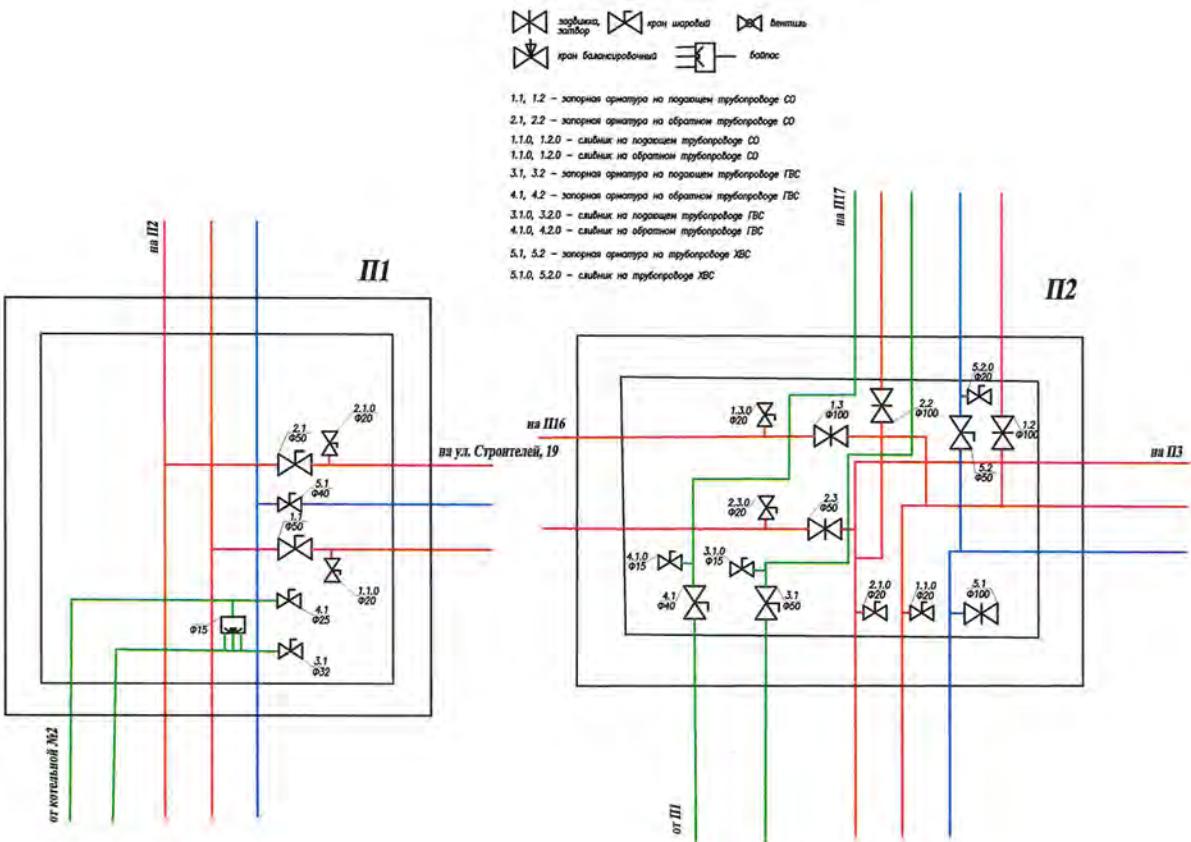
Механическое оборудование от котельной №2 до теплового колодца П36 «Пождепо»
